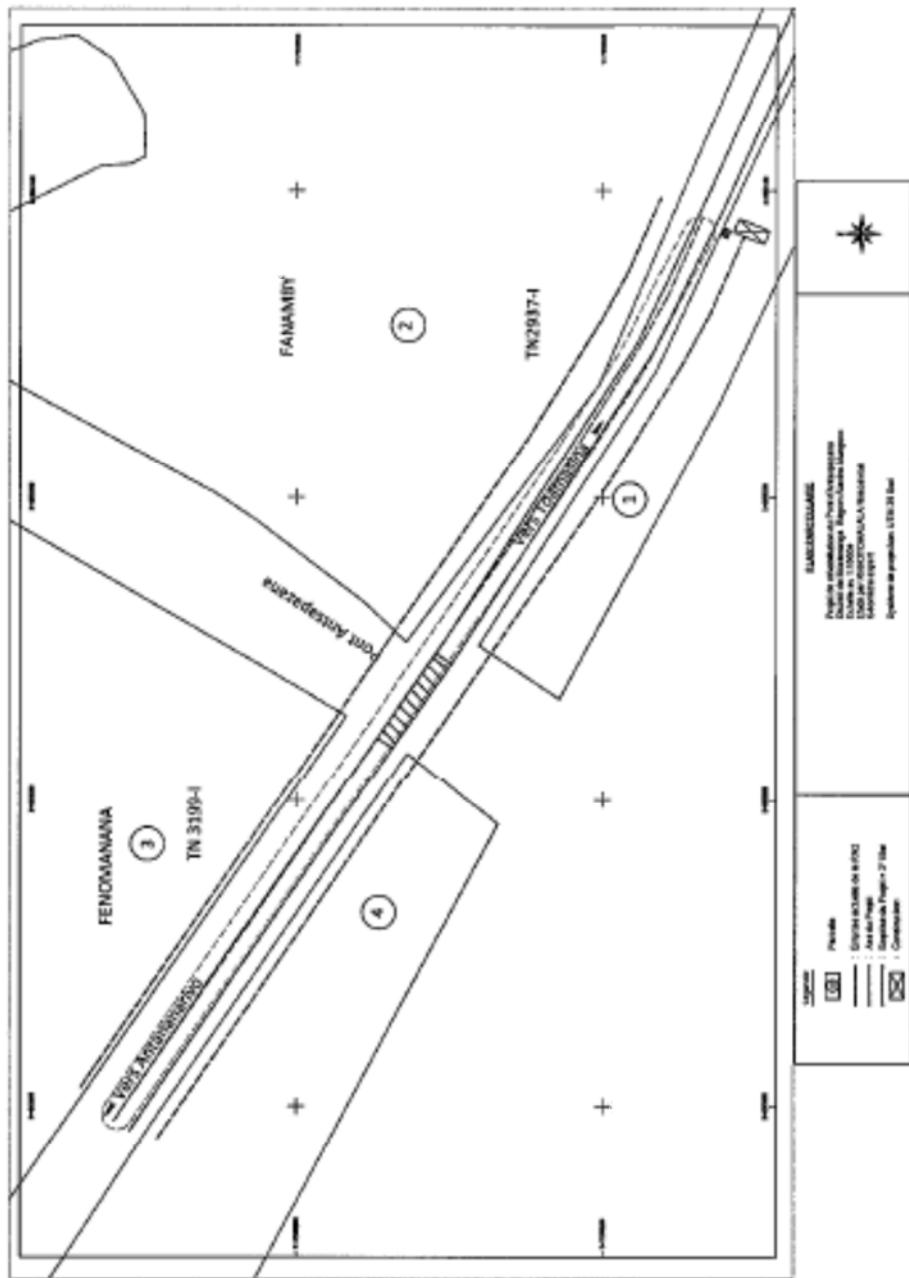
PLAN PARCELLAIRE - ANTSAPAZANA
